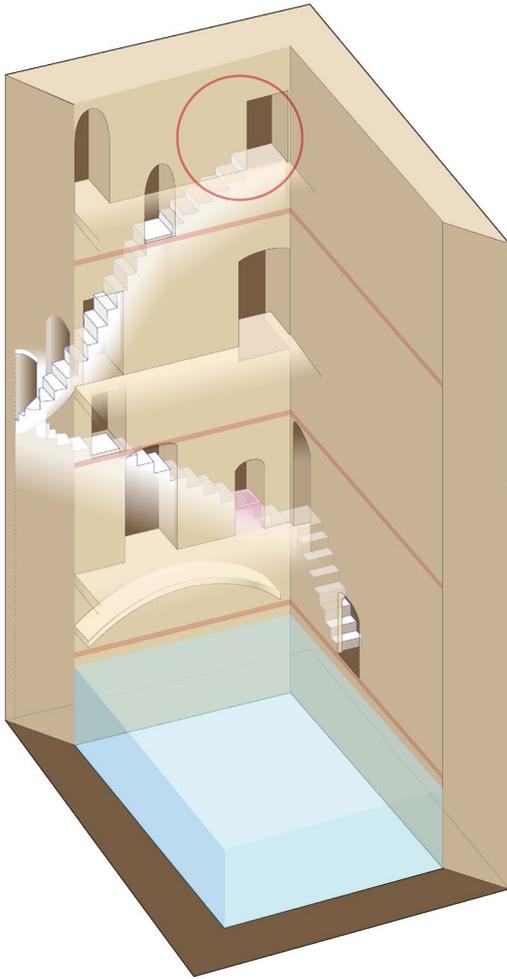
Reconstrucción esquemática de la escalera (M. Salvatierra)
